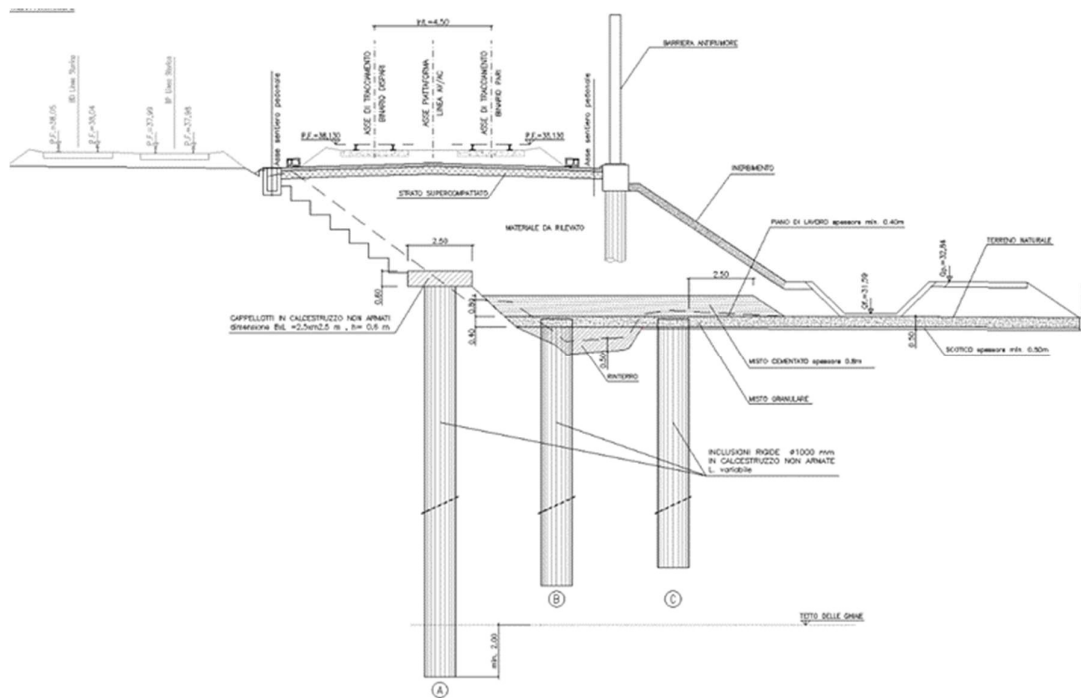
Progetto Esecutivo - sezione di intervento Ri46
